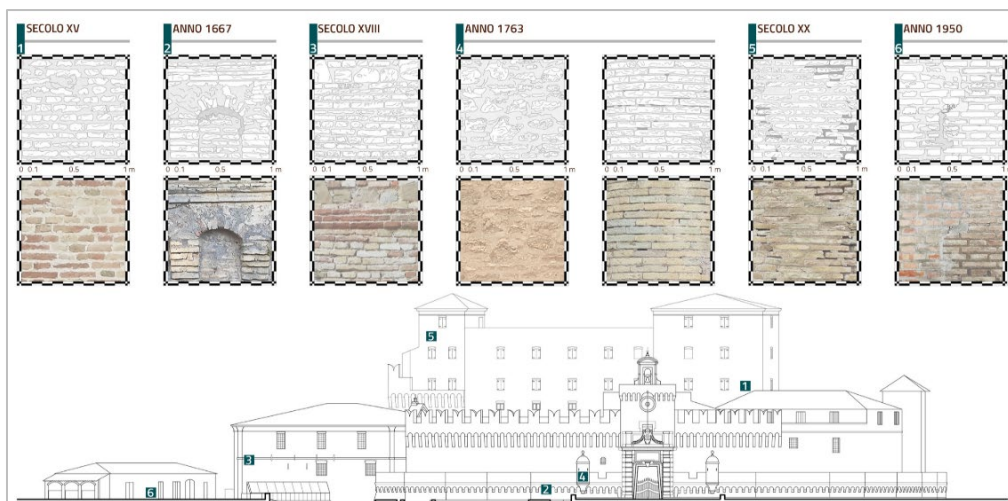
Il prospetto ovest della rocca di Fiumesino con l'individuazione dei campioni murati analizzati.
